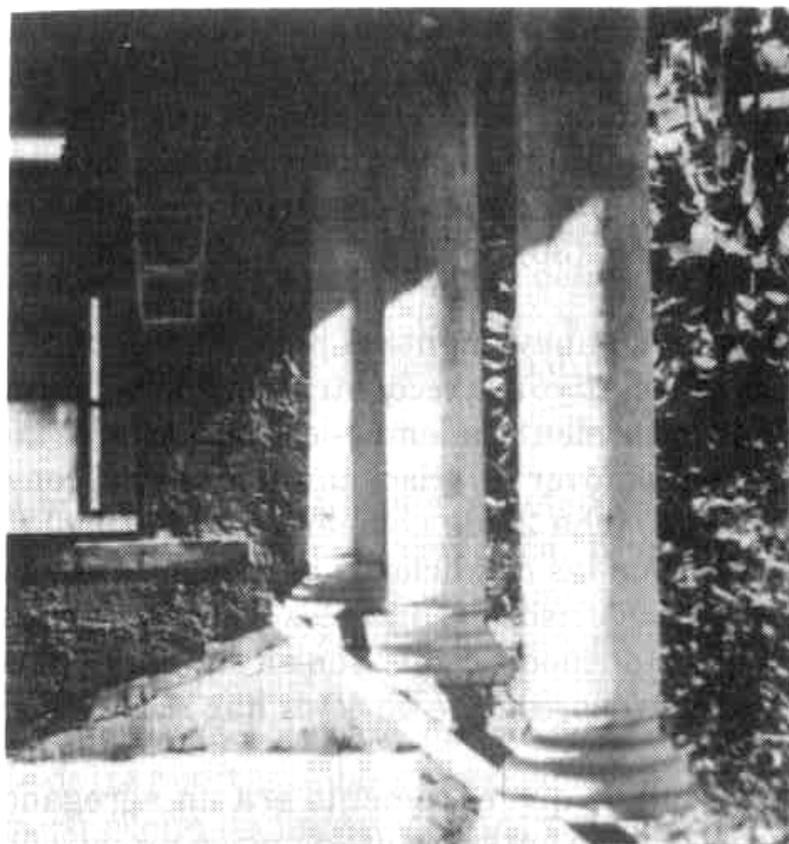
Viga adintelada sobre zapatas y columnas, 1980
